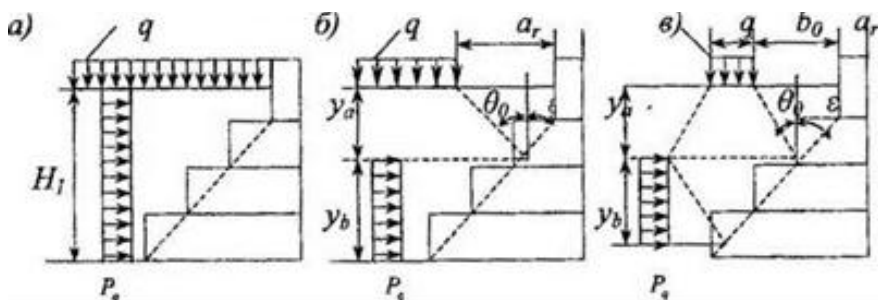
Схемы давления грунта на пирамиду продавливания: а)- от сплошной нагрузки; б)- от фиксированной нагрузки; в)- от полосовой нагрузки
